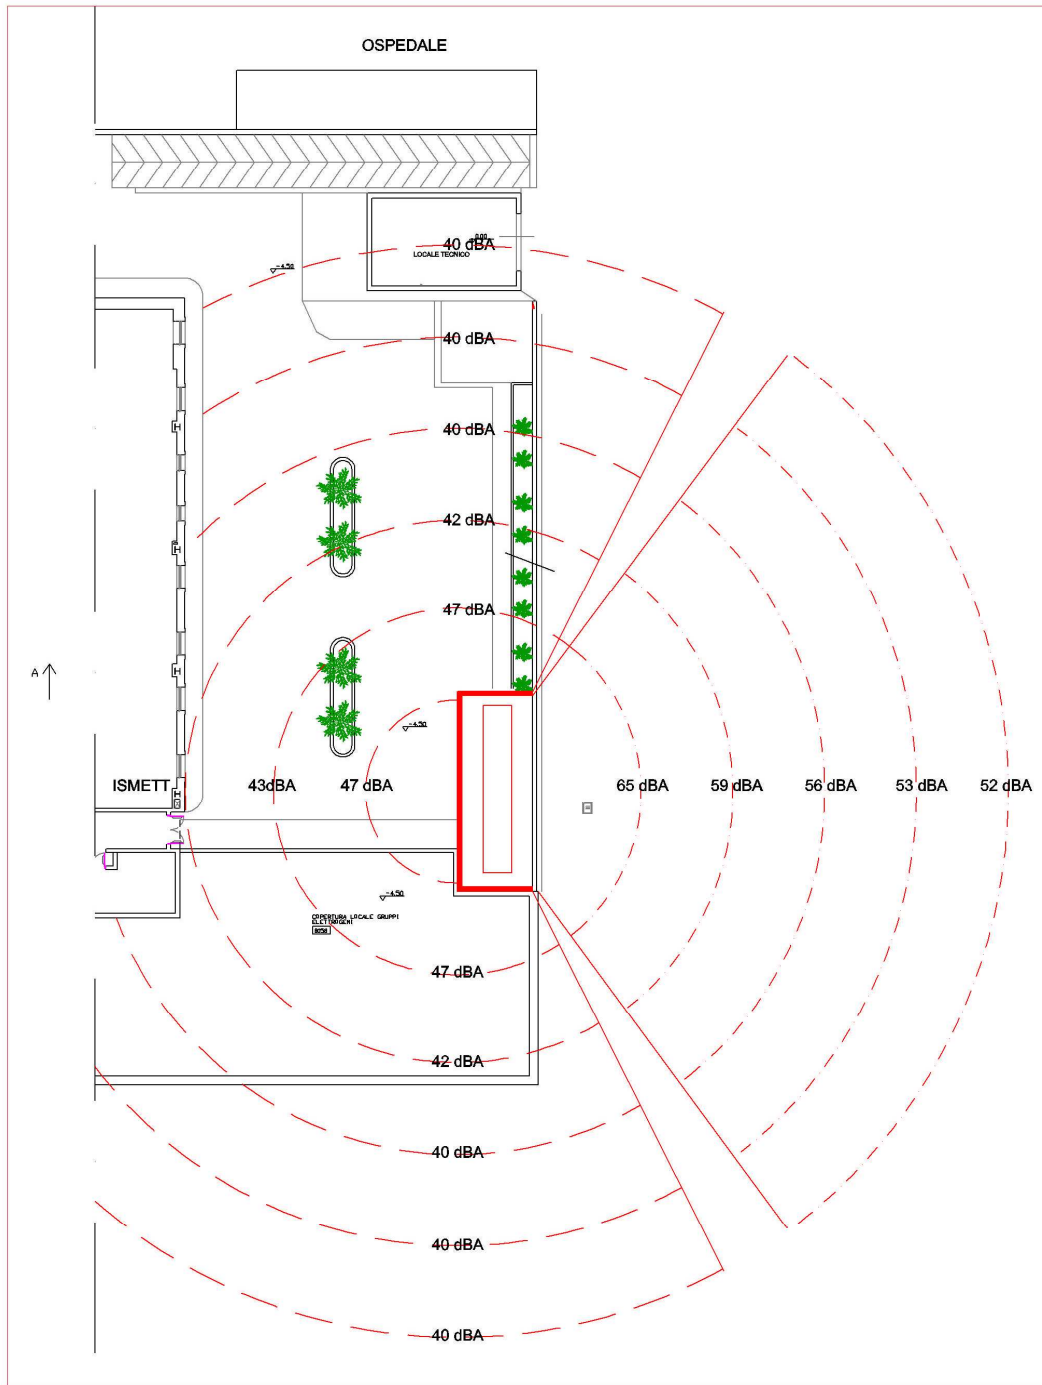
Pianta con indicazione della forma a "C" della Barriera
